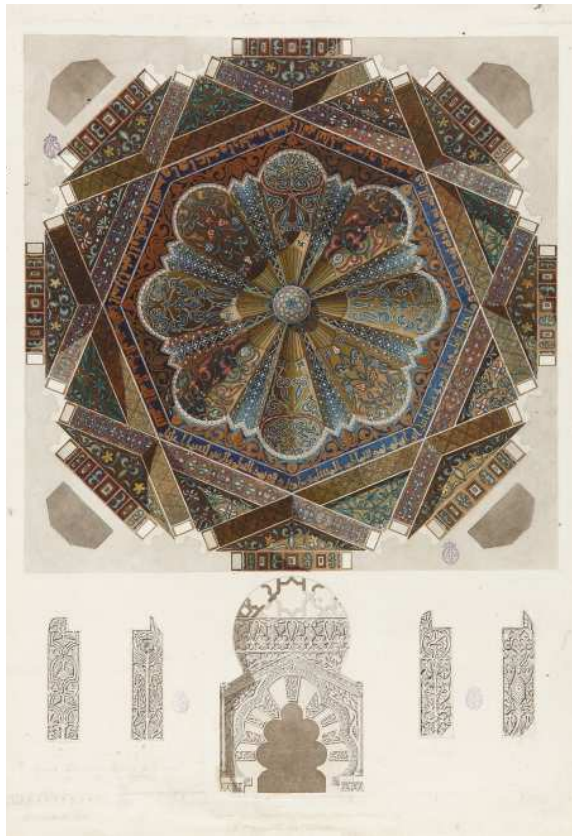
Arredondo, R. (1874). Planta de la bóveda central de la macsura.
